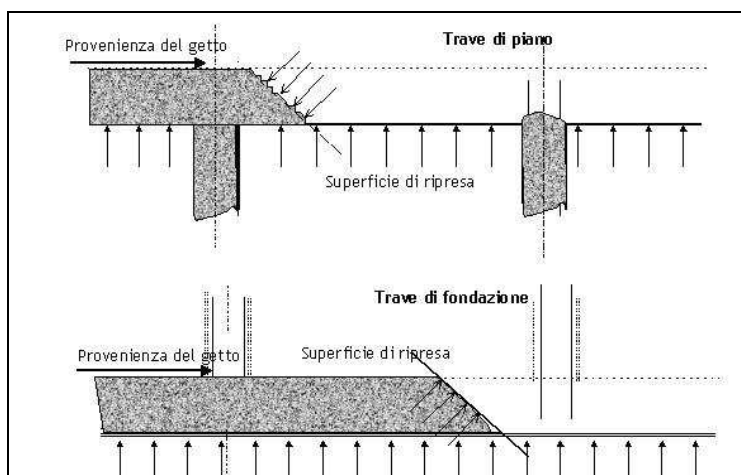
Ripresa di getto in travi di piano e di fondazione
